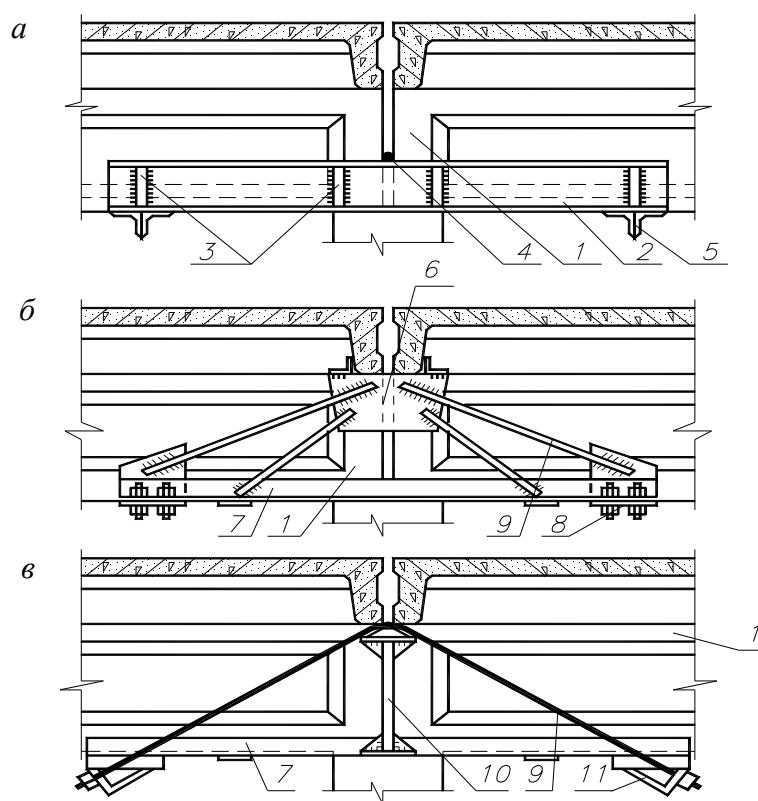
Усиление конструкций дополнительными упругими опорами в виде двухконсольных кронштейнов: *а* – из прокатных профилей; *б, в* – из треугольных ферм: 1 – усиливаемая конструкция, 2 – стальная балка, 3 – ребра жесткости, 4 – соединительный стержень или пластина, 5 – опорный столик, 6 – соединительная накладка, 7 – уголок, 8 – опорный элемент, 9 – тяж, 10 – упор
